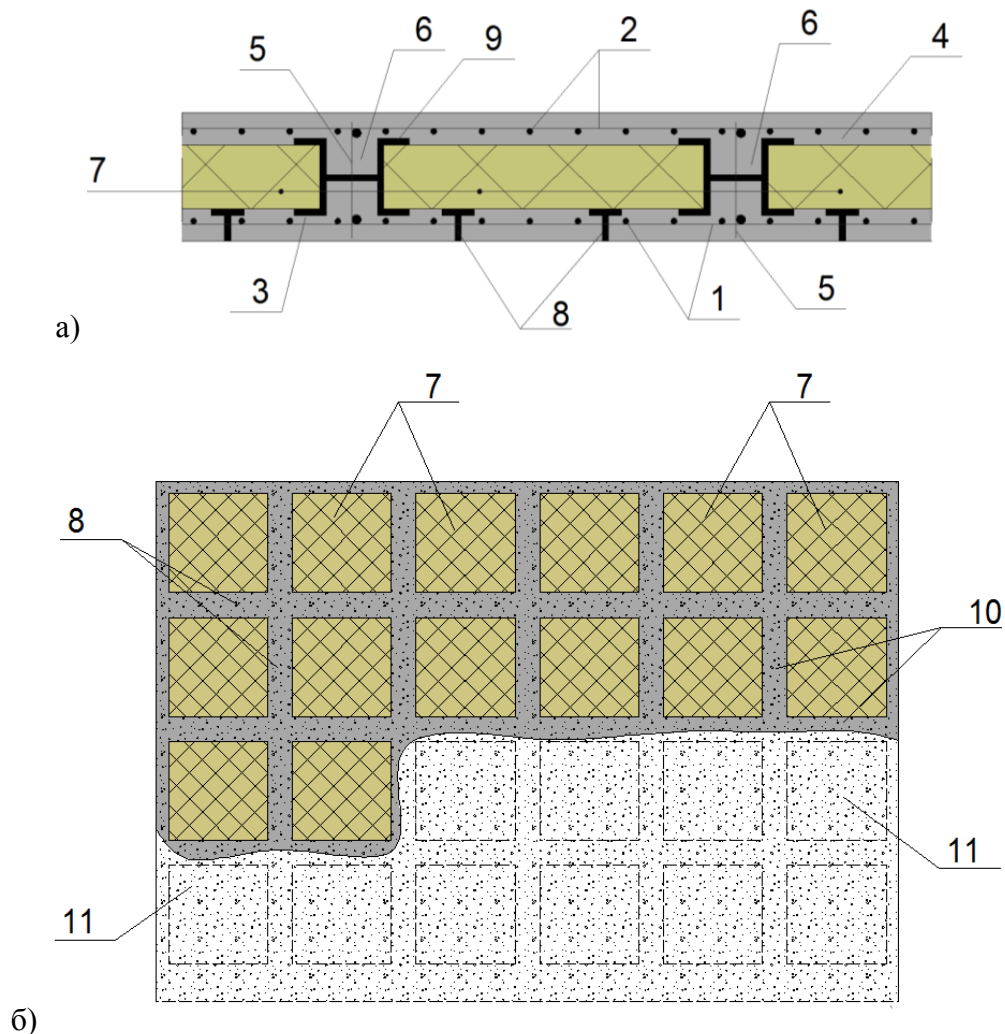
Спосіб влаштування полегшеного залізобетонного перекриття: а) поперечний переріз перекриття; б) послідовність бетонування перекриття; 1 і 2 - арматура нижньої і верхньої сітки; 3 і 4 - нижня і верхня обшивка; 5 - арматурні каркаси; 6 - ребра перекриття; 7 - вкладиші; 8 і 9 - фіксатори; 10 - зазор між вкладишами; 11 - бетонування верхньої частини перекриття
